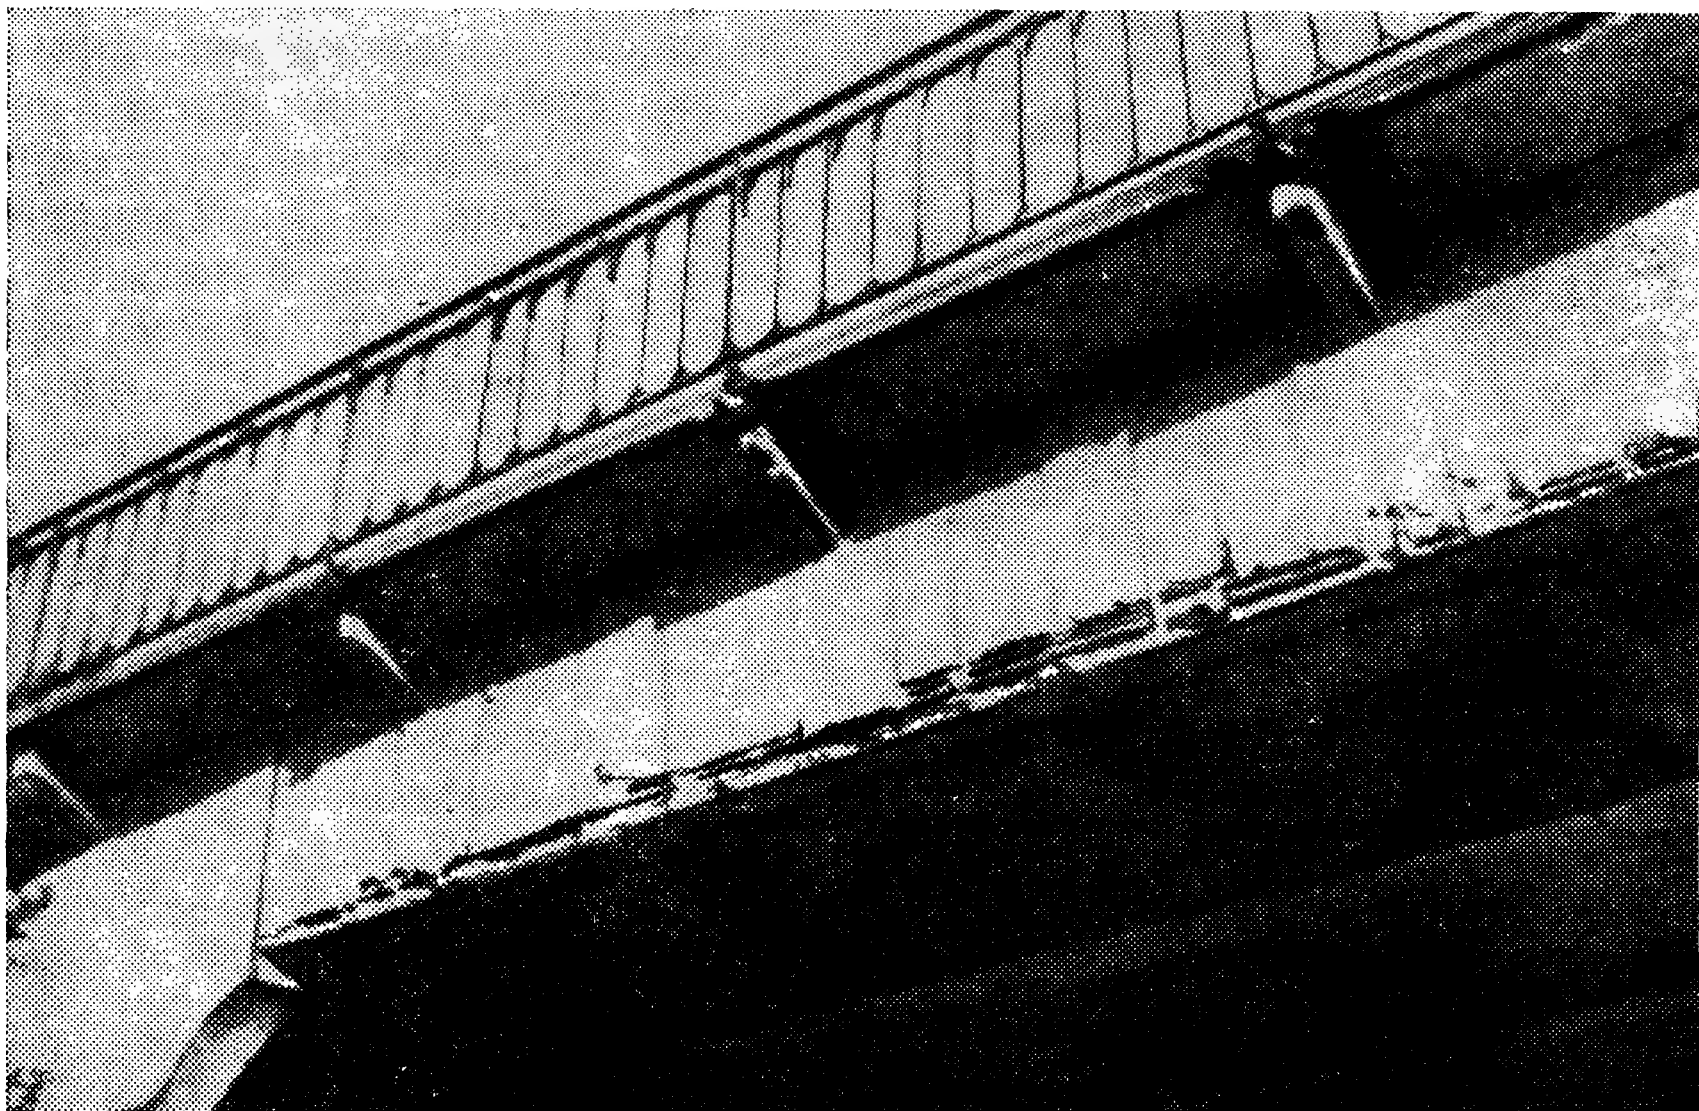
Коррозионные повреждения в нижней части железобетонного моста
